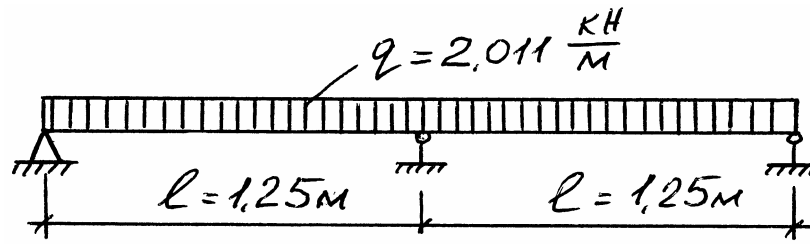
Розрахункова схема настилу при першому сполученні навантажень
